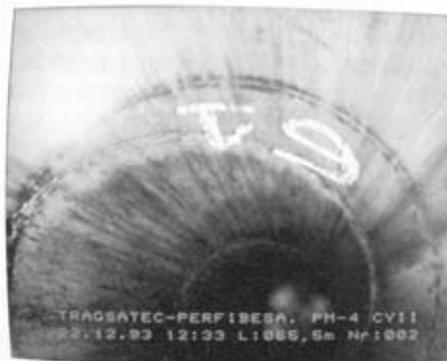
Control final de la columna de entubación del sondeo mediante inspección con televisión. Se aprecia la numeración interna de los tramos de tubería (foto TRAGSATEC).
